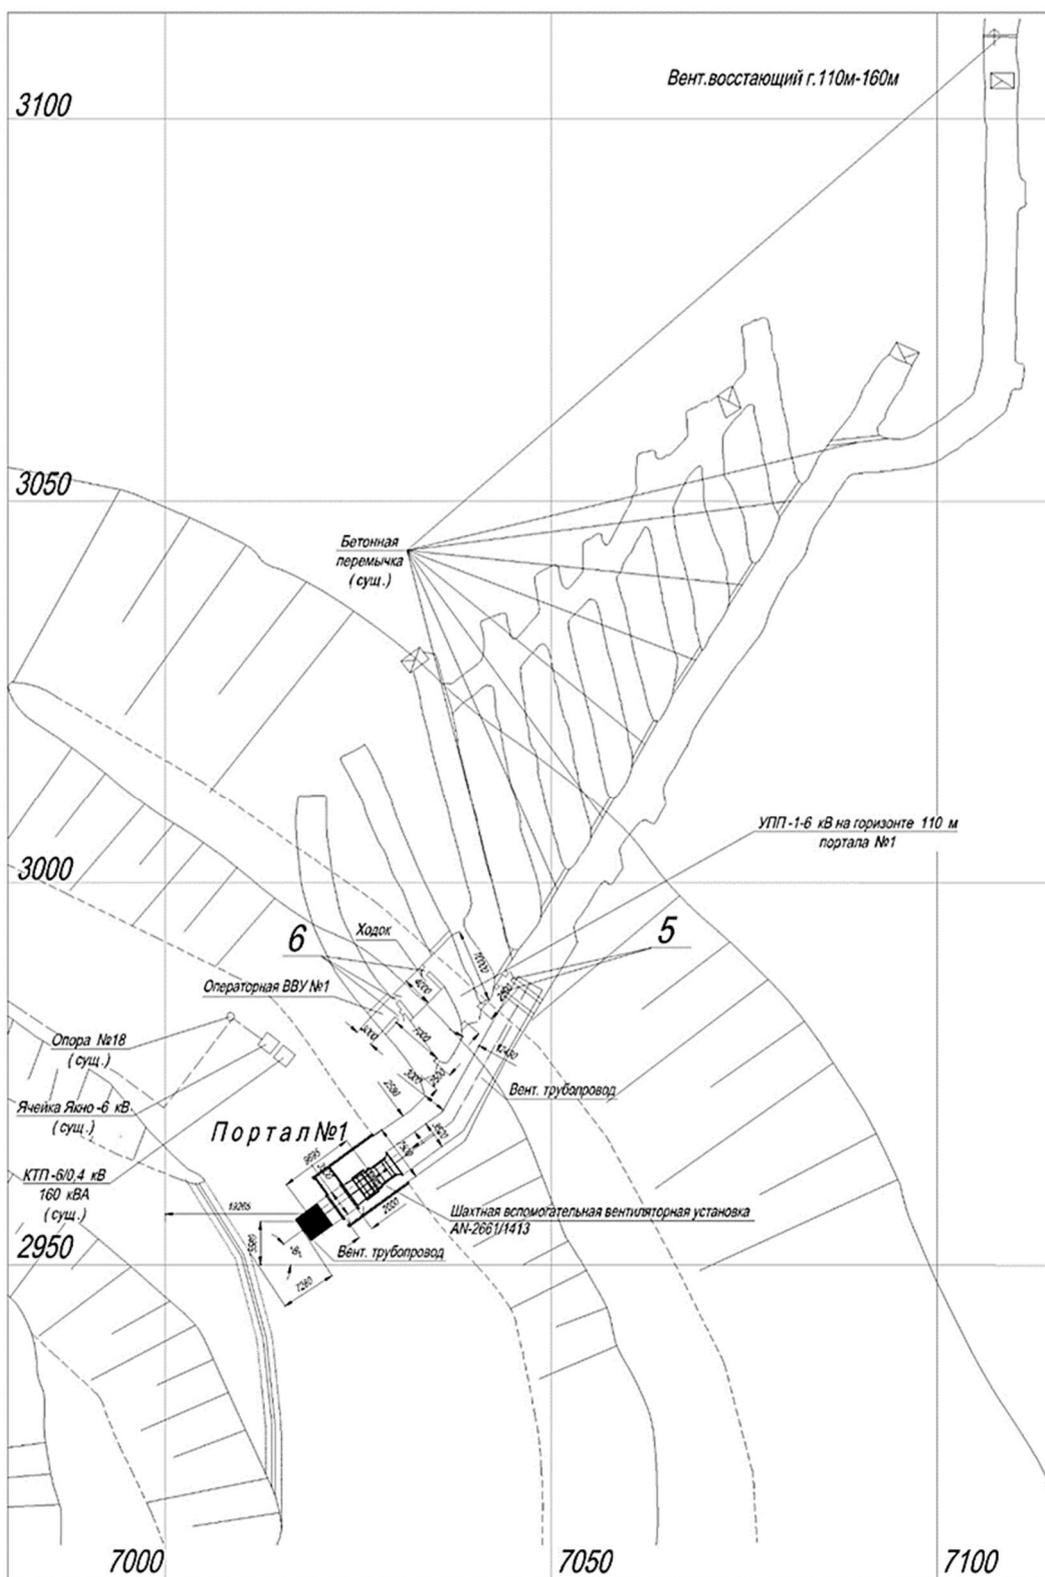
Схема размещения вспомогательной вентиляционной установки на плане портала № 1 горизонта 110 м.
